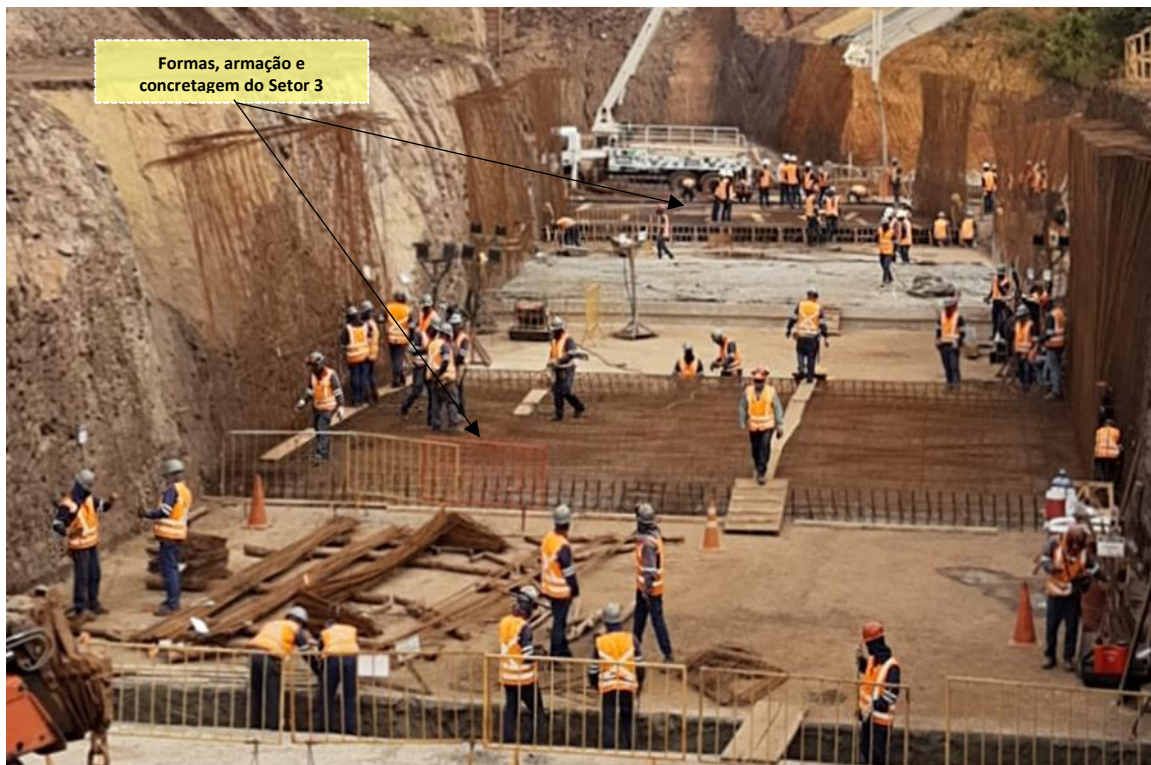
Forma, armação e concretagem na laje de fundo do Setor 3
